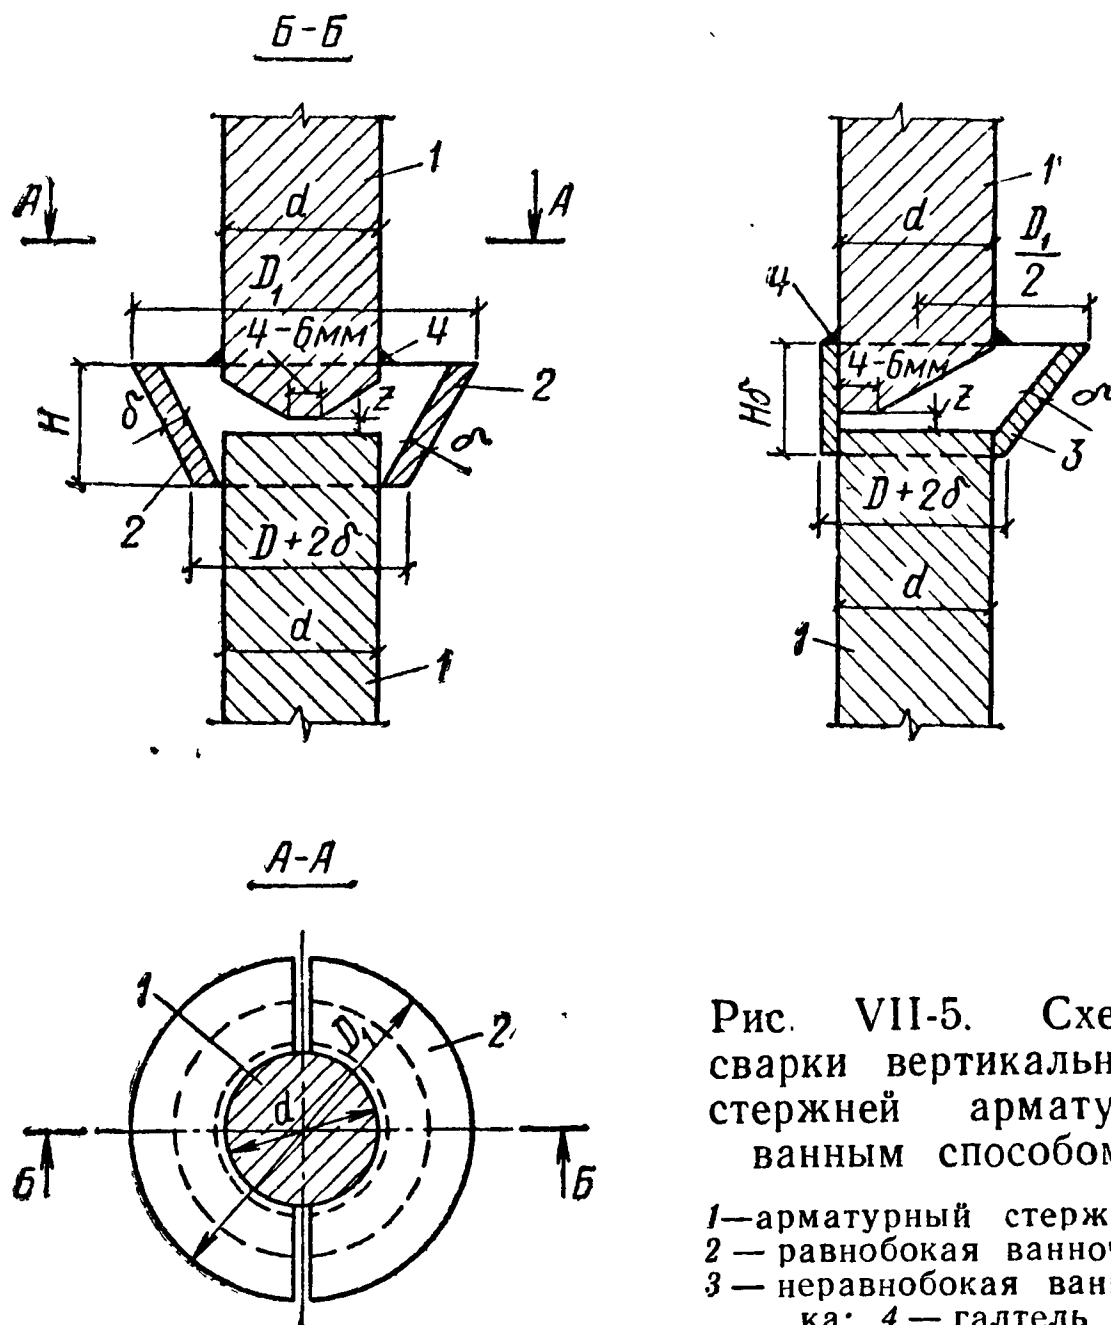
Схема сварки вертикальных стержней арматуры ванным способом
